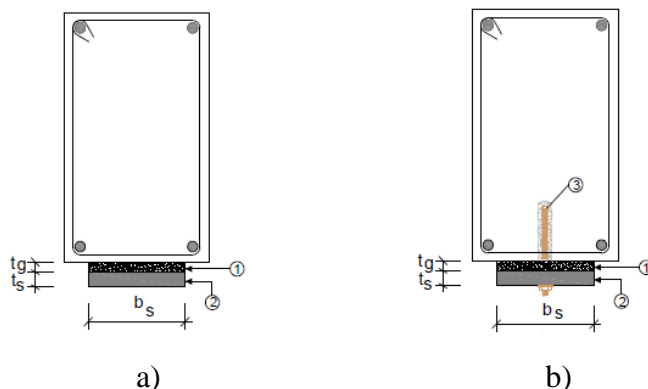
Reforço de vigas à flexão (dimensões recomendadas): a) sem buchas metálicas; b) com buchas metálicas; adaptado de Sousa (2008)
